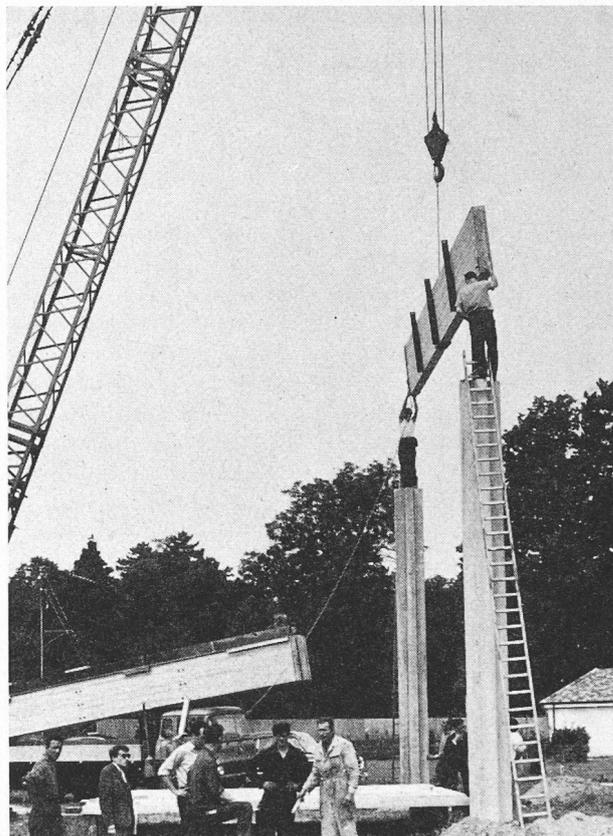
et 16 bis. — Montage du prototype de structure. Poutres en bois collé sur poteaux en béton.
